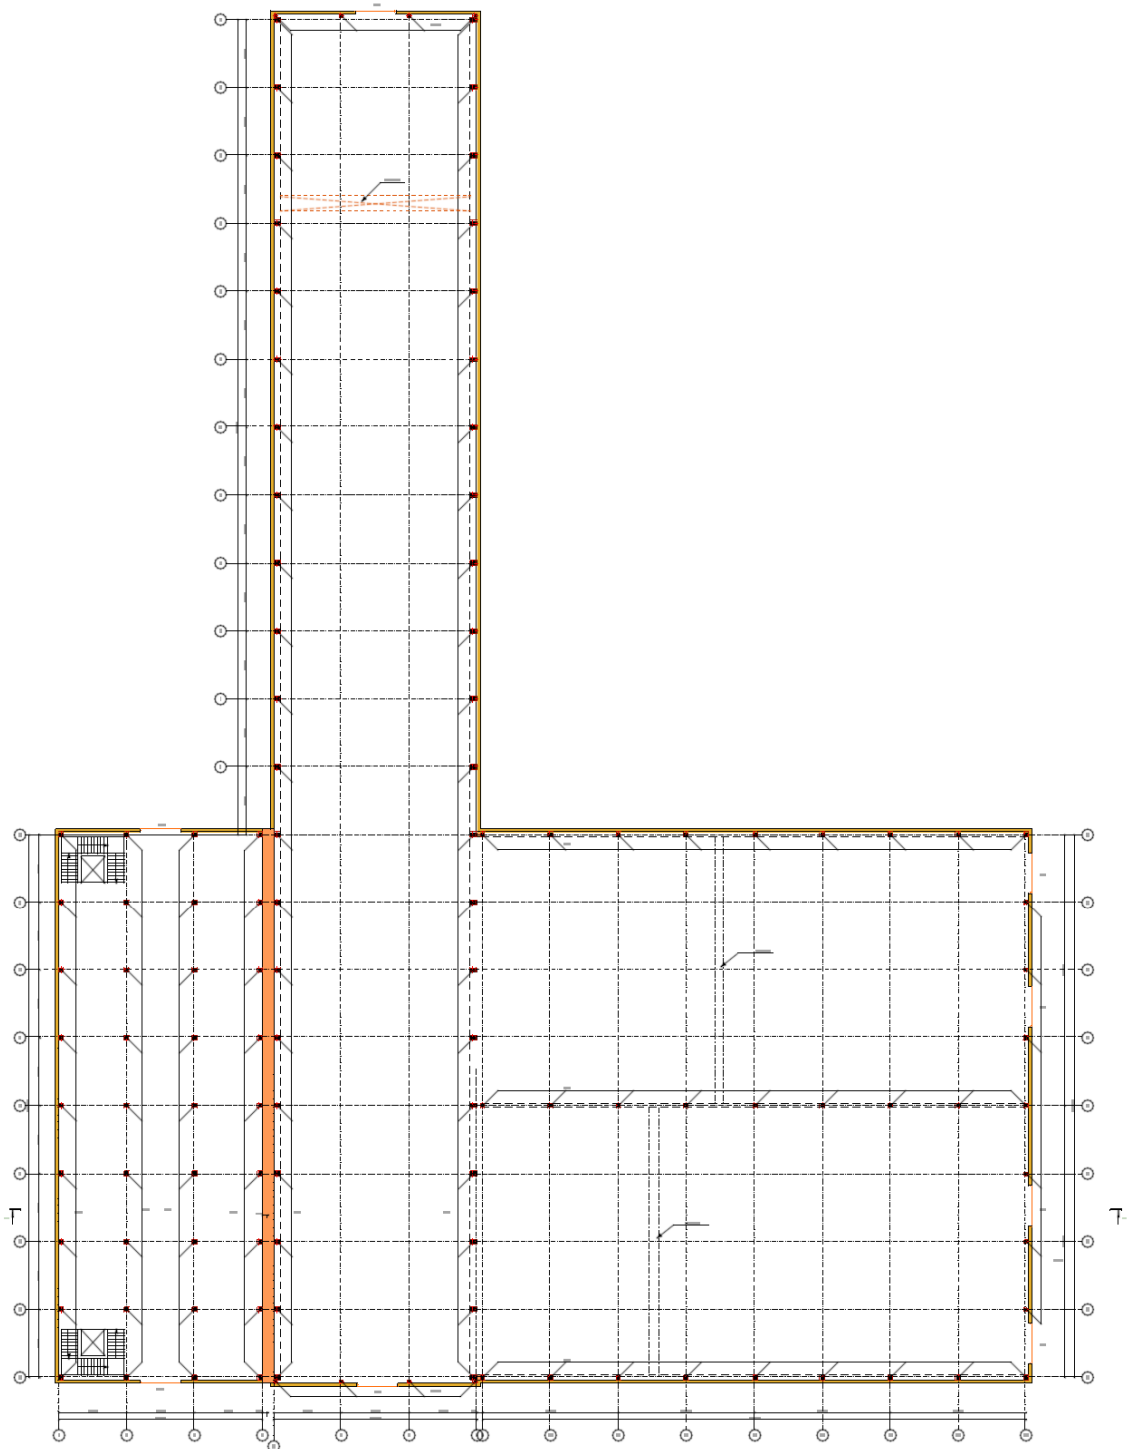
План-схема розташування конструкцій каркаса одноповерхової та багатопверхової промислової будівлі
